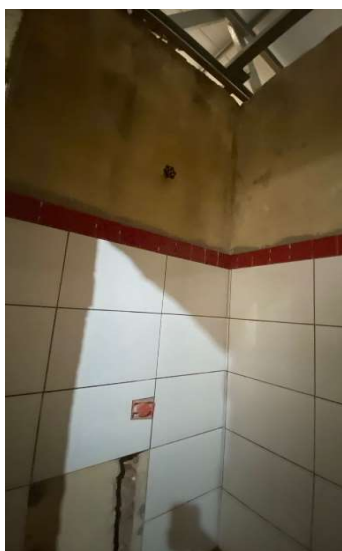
REGISTRO DE GAVETA BRUTO, LATÃO, ROSCAVEL, 1 1/2, COM ACABAMENTO.
